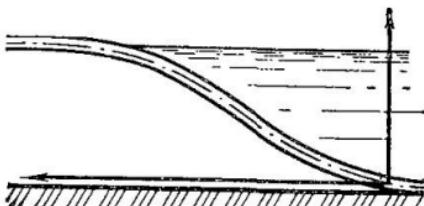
Схема укладки трубо-проводов свободным погружением
